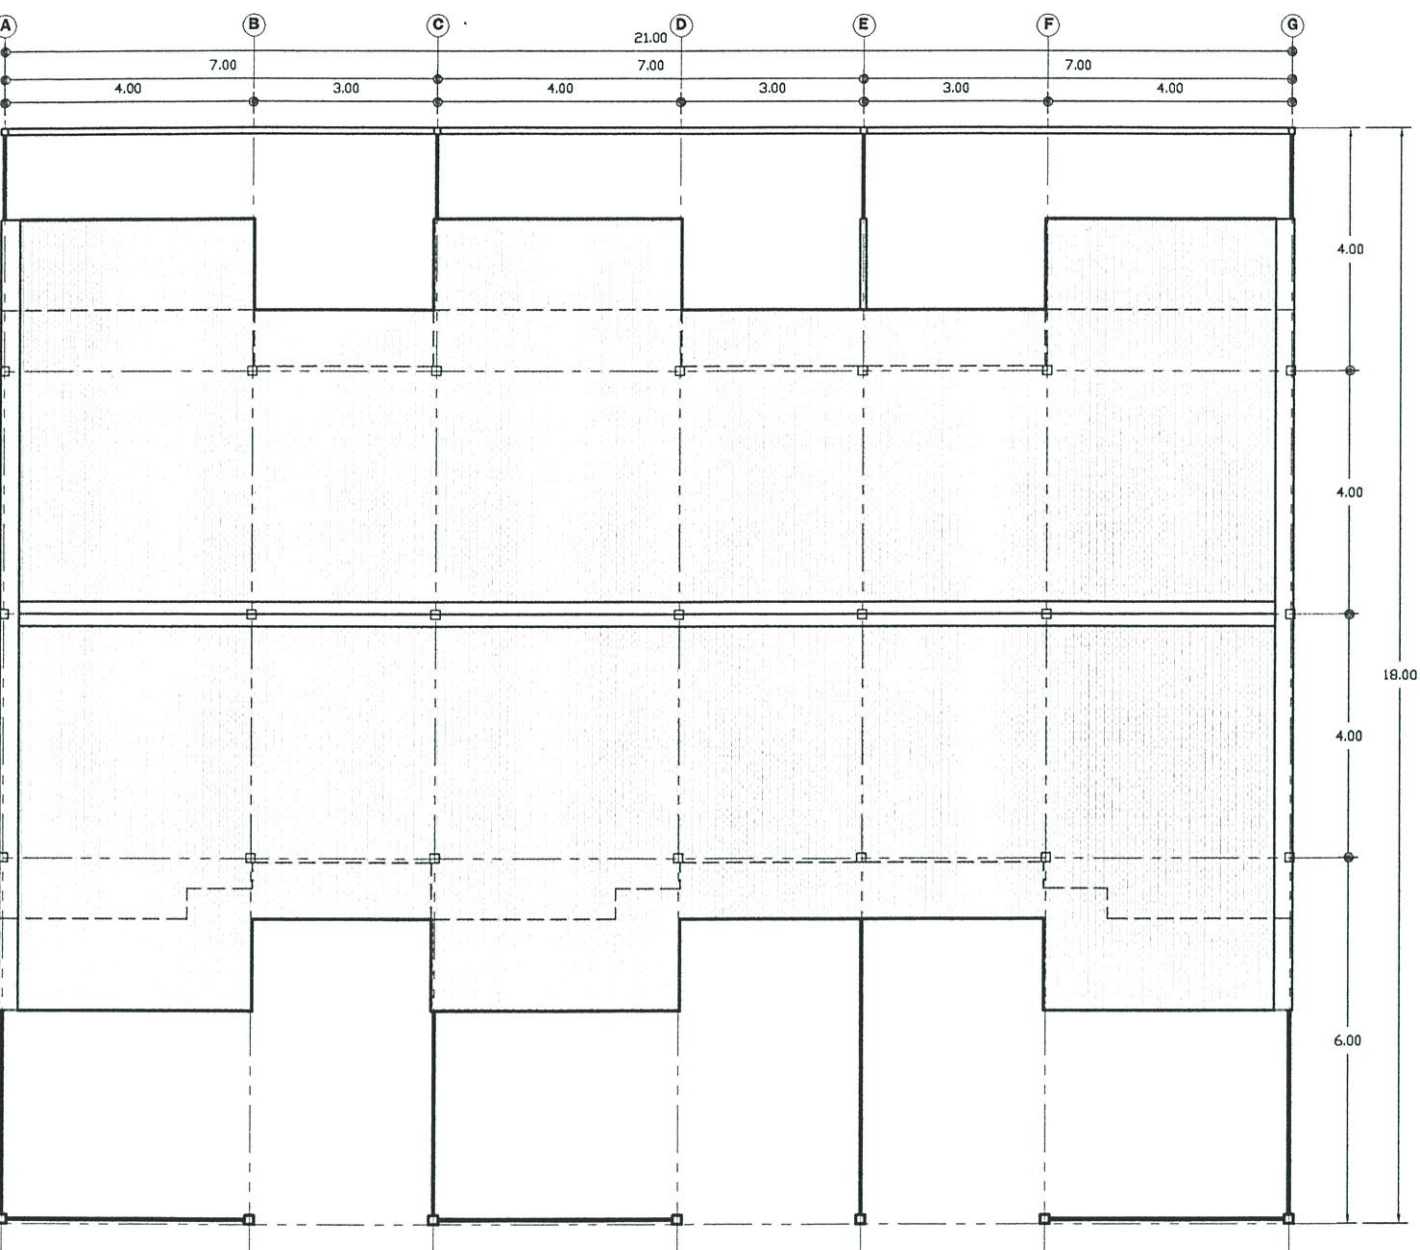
แสดงผังบริเวณบ้านแถวชั้นเดียว
